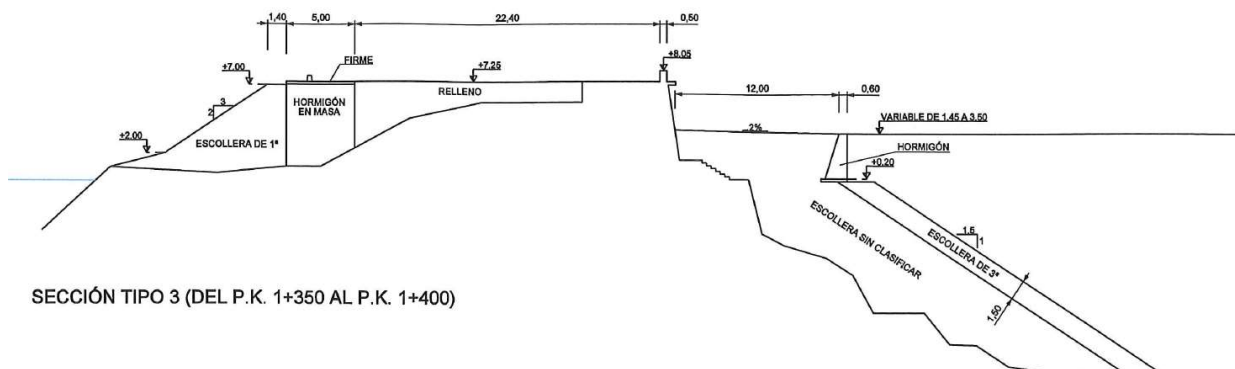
Sección tipo 3 correspondiente al primer tramo con manto de escollera
